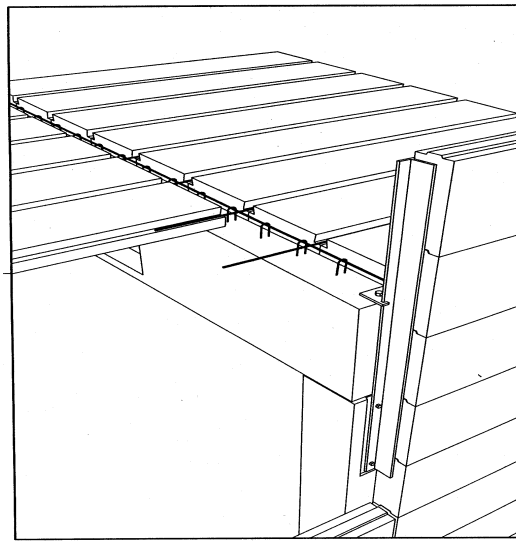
Voorbeeld van een stijve dakschijf met betonplaten of elementen in cellenbeton. De kettingwapeningen in de langse en dwarse voegen moeten verbonden worden met de wachtstaven uit de dakbalken.
